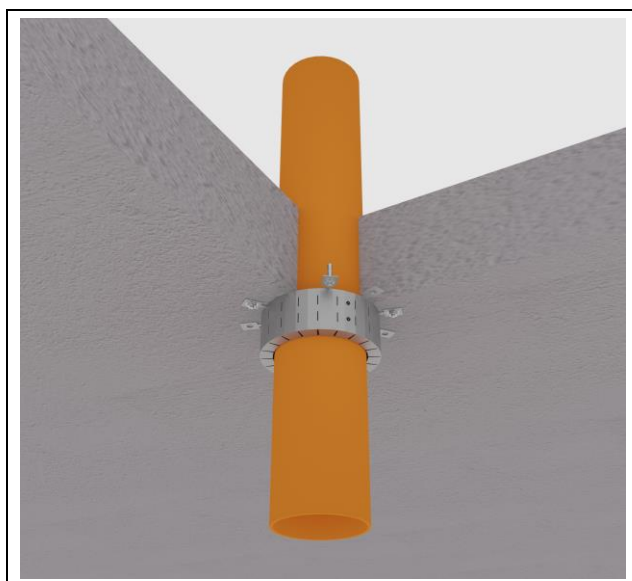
Esempio di sigillatura di attraversamenti di tubazioni di plastica in un solaio rigido.
